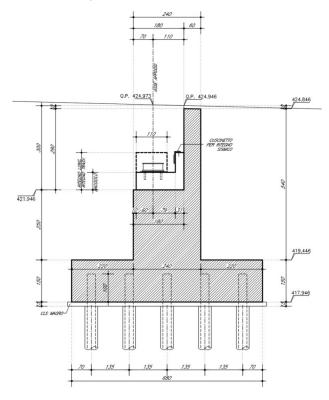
Sezione in asse tracciamento spalla B
